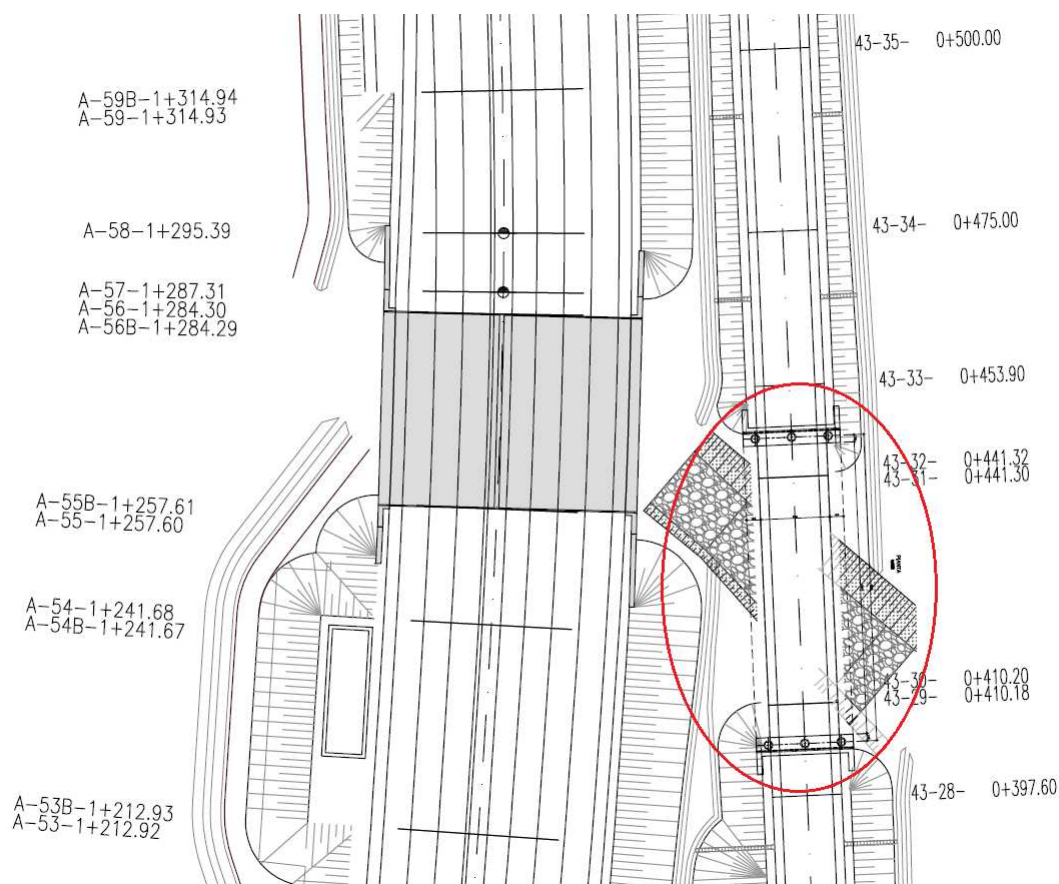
INDIVIDUAZIONE DELL'IMPALCATO ALL'INTERNO DELLA PLANIMETRIA GENERALE
